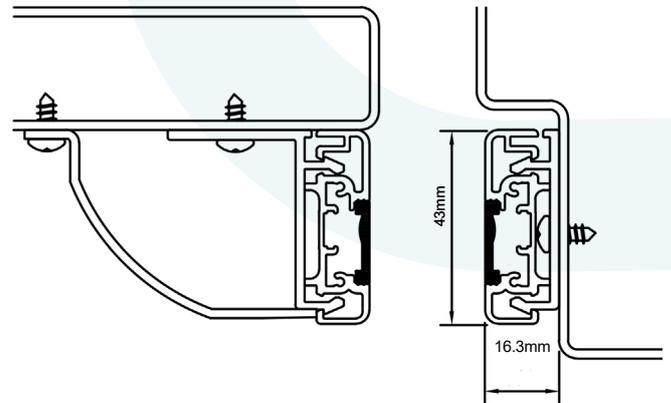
Perfil de 43 mm montado para apertura lateral con un soporte en "L" con protección para los dedos y soporte de poste de cierre
